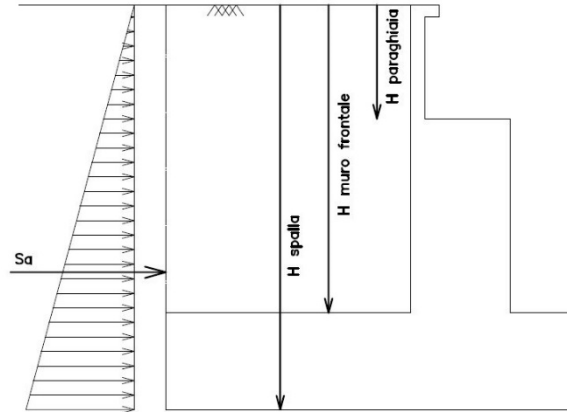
Schema per il calcolo degli effetti della spinta statica del terreno
